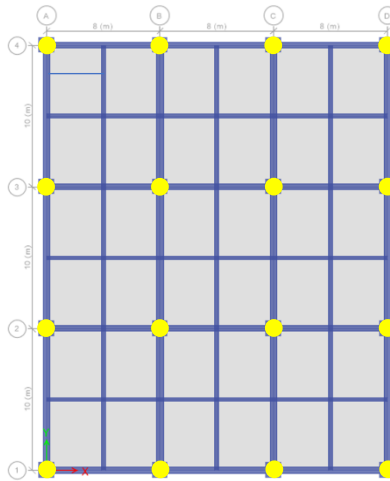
Configuración de los aisladores en la planta del edificio de 20 niveles
